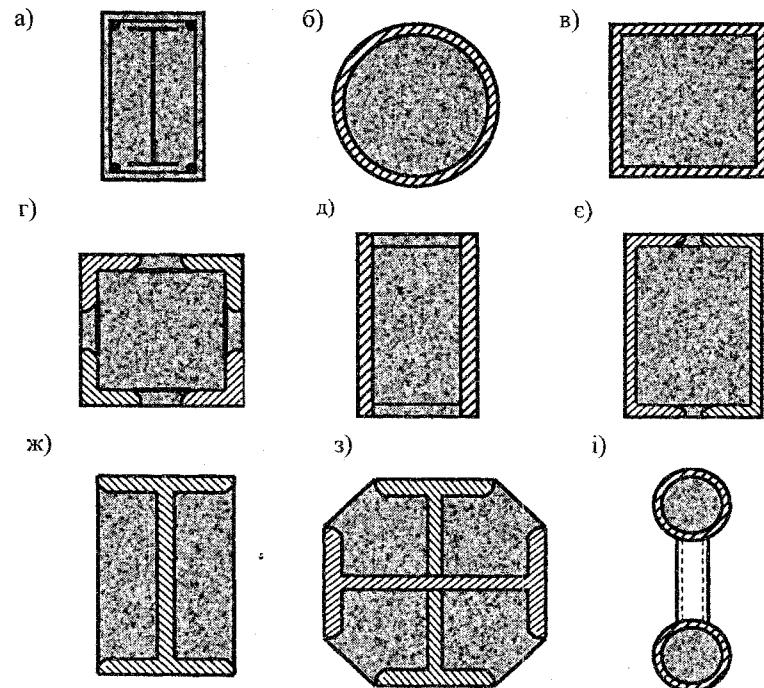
Поперечні перерізи сталезалізобетонних колон:
